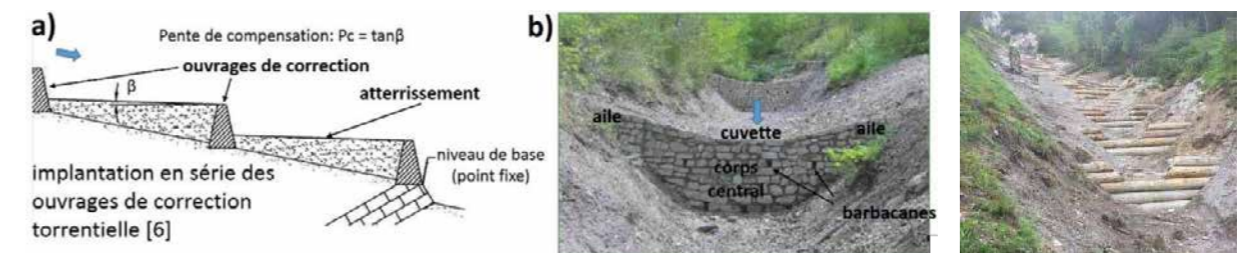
Schéma et exemple d'aménagement de correction torrentielle.
